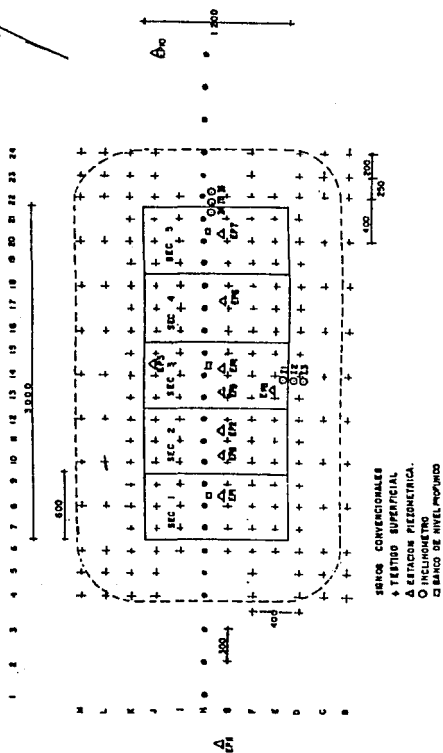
PLANTA DE LOCALIZACION DE INSTRUMENTOS (R+I. 29)
